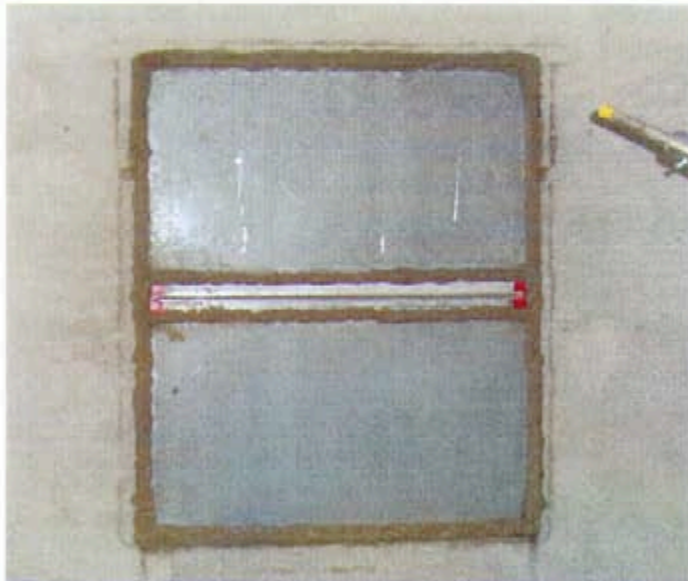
Foto des eingebauten Elementes (erstellt vom ift Schallschutzzentrum)
